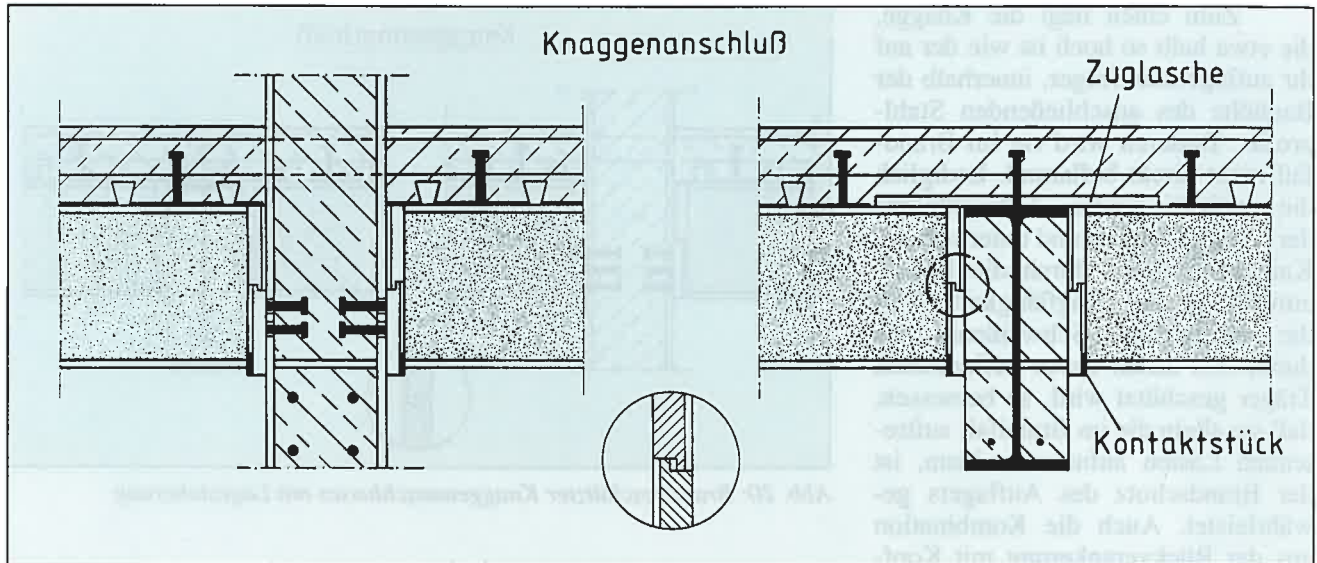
Durchlaufwirkung mittels Zuglasche, Bewehrung und Druckkontakt
